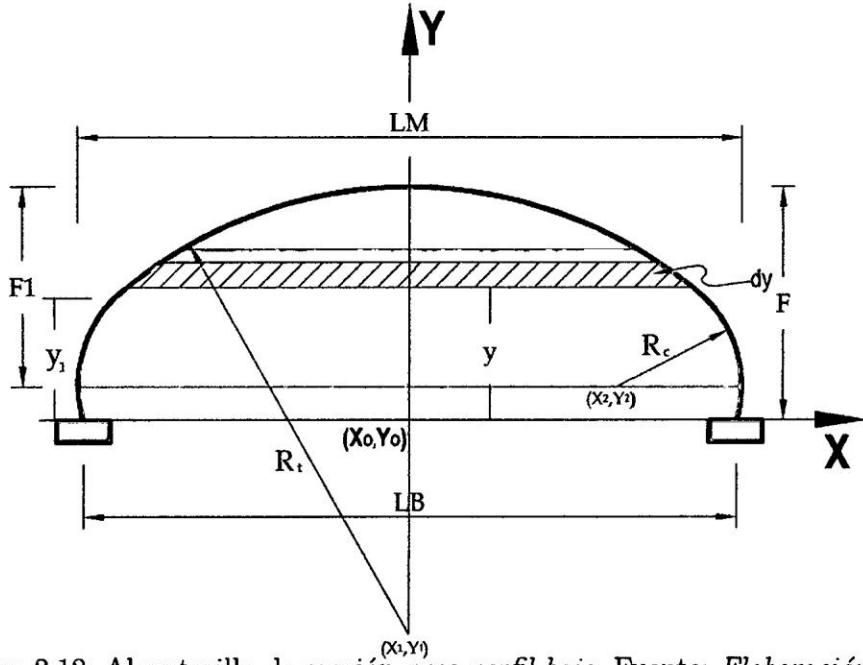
Alcantarilla de sección arco perfil bajo. Fuente: *Elaboración propia
